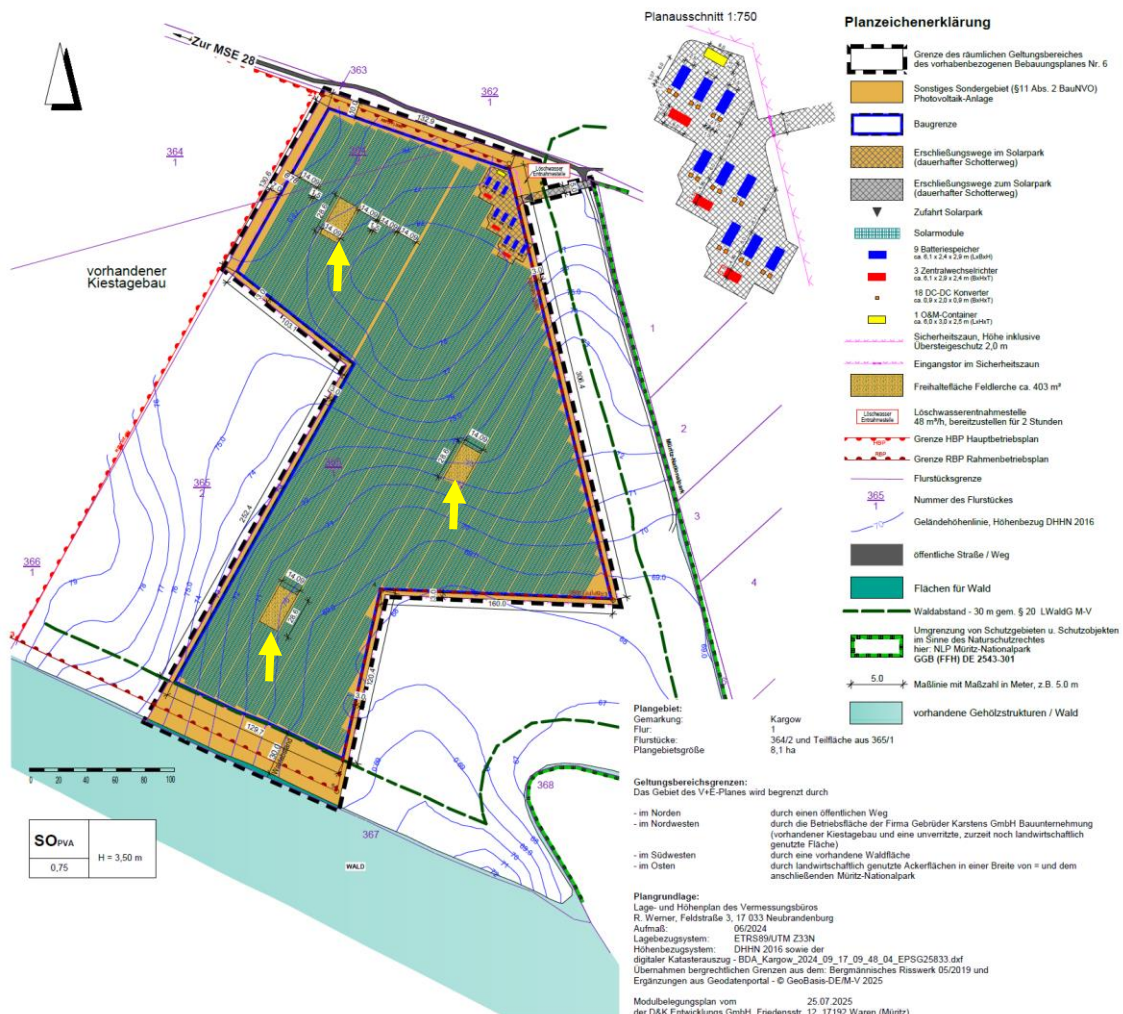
Räumliche Lage für insgesamt drei „Lerchenfenster“ (gelbe Pfeile) innerhalb der PV-Freiflächenanlage. Quelle: Vorhaben- und Erschließungsplan.
